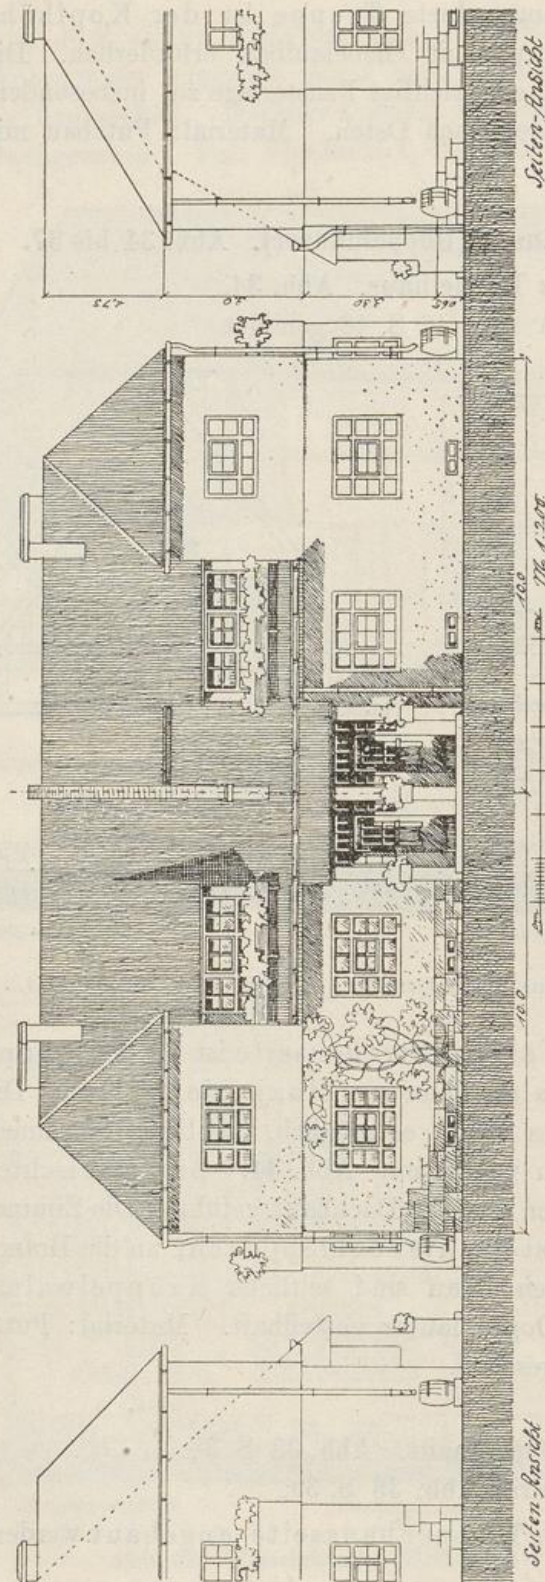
Symmetrisches Doppelhaus für zwei Familien. Seitliche Gebäudeteile mit zwei Stockwerken, links Satteldach, rechts Mansarde über Grundriß Abb. 36 S. 39.
